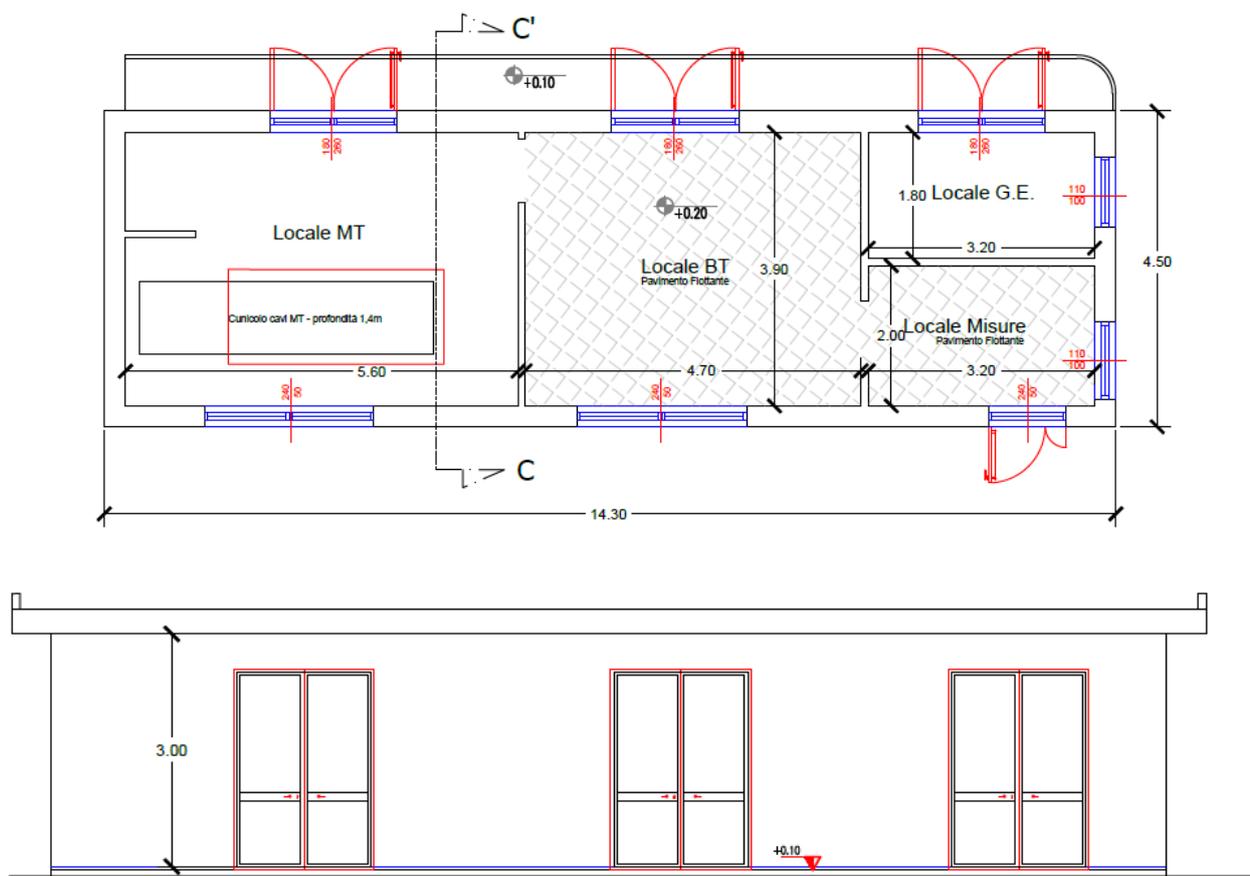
Vista in pianta e laterale del locale tecnico SE utente
